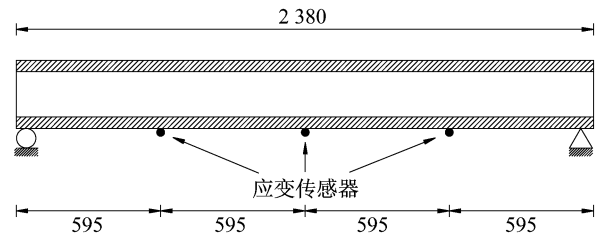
实验桥梁模型上应变传感器布置示意图 (单位: mm)
